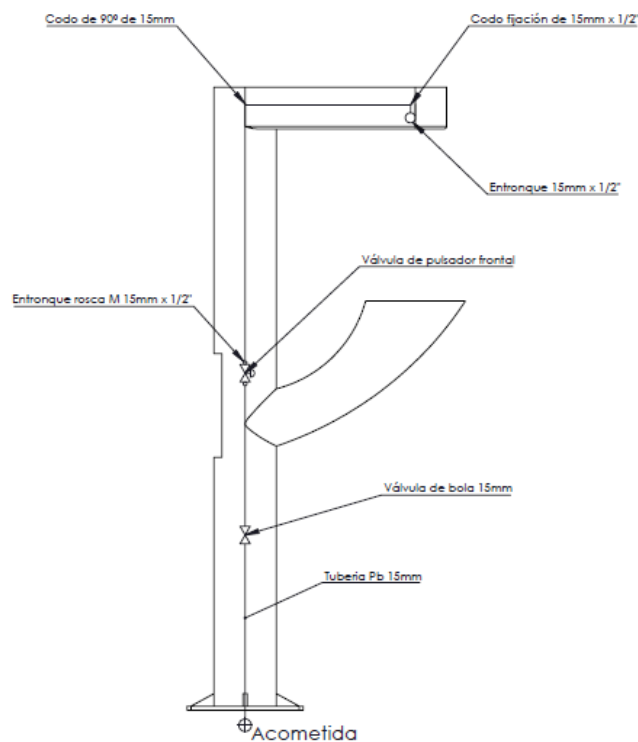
Esquema de fontanería de la Fuente para rellenar botellas Fuente: Elaboración propia
